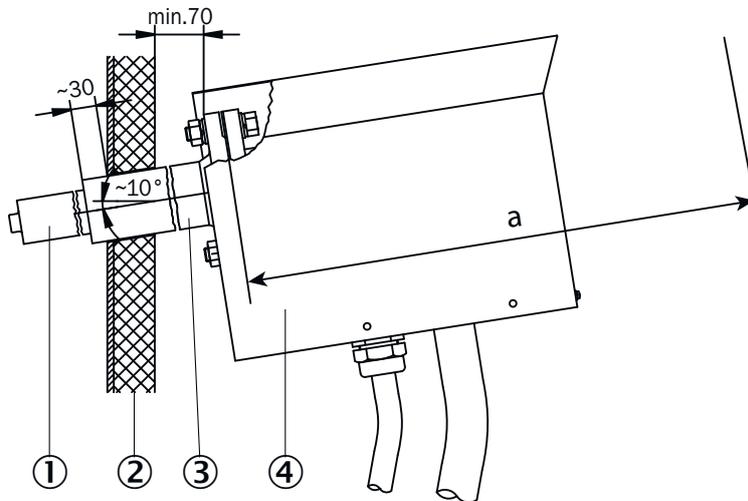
Montagevorgaben Vorschweißflansch
